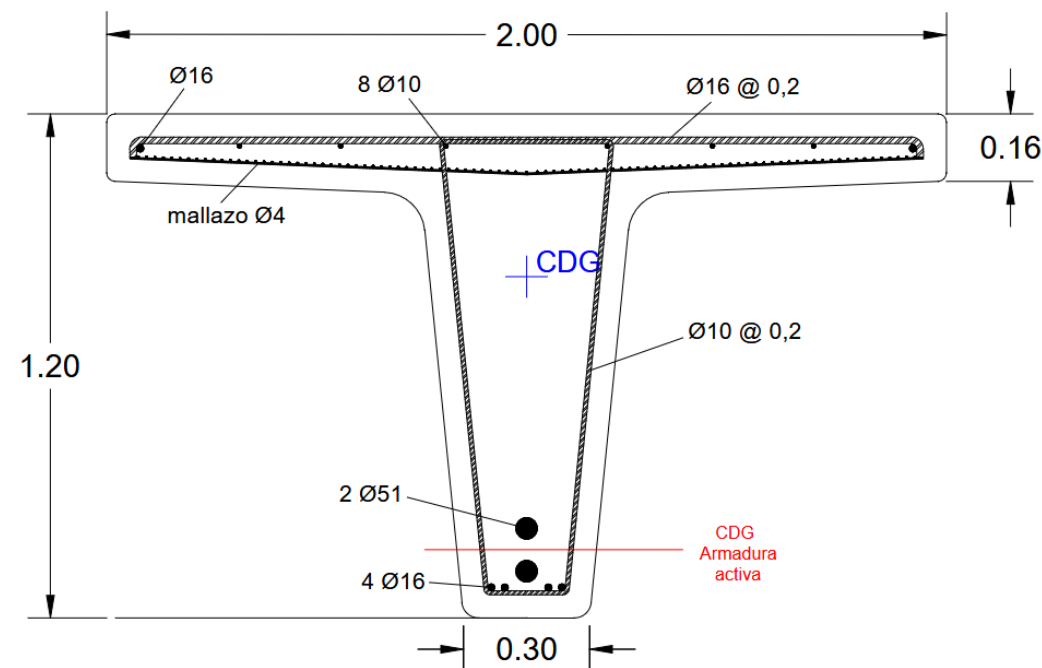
Predimensionamiento de la sección de hormigón pretensado. Fuente: Elaboración propia
